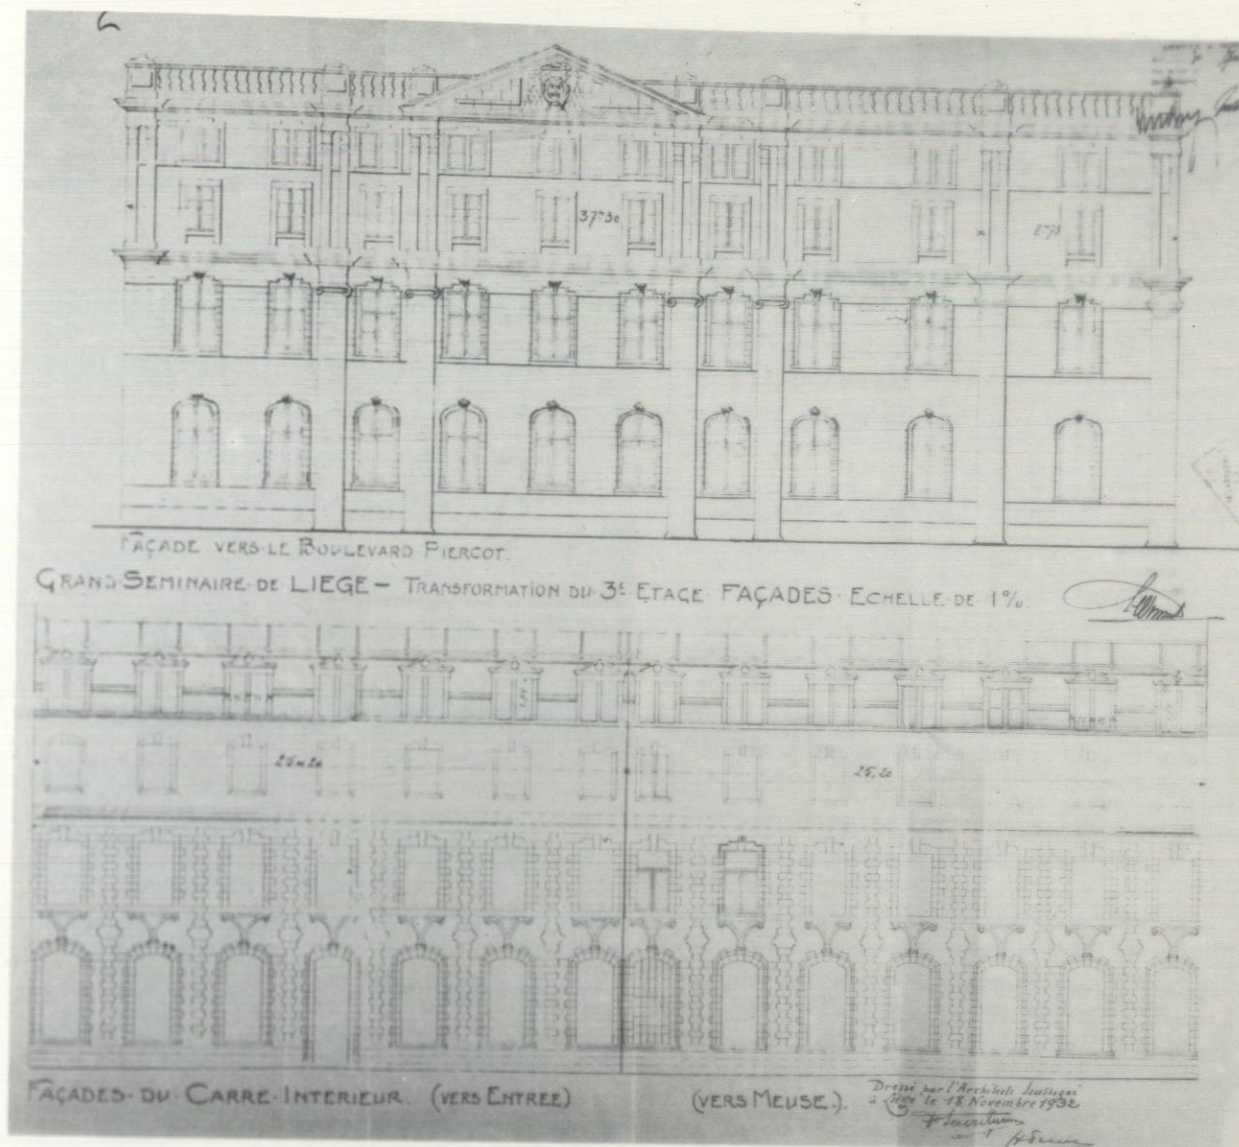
Plan de transformation du 3e étage du Grand Séminaire (1932). Elevations de la façade vers le boulevard Piercot et d'une des façades intérieures. Liège, Archives de l'Evêché, Fonds Kerkhofs, 54. Cliché M. Botty.
